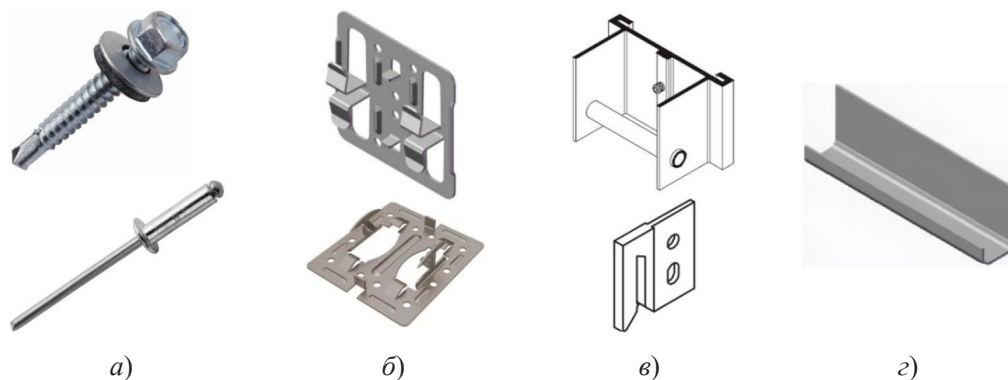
Элементы крепления облицовочных материалов навесного вентилируемого фасада:
